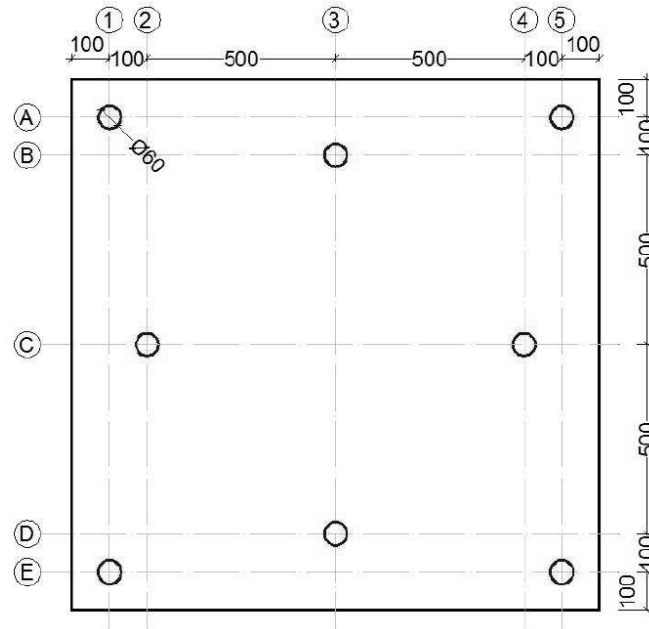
Planta do pavimento, medidas em cm (COLONESE, 2008).
